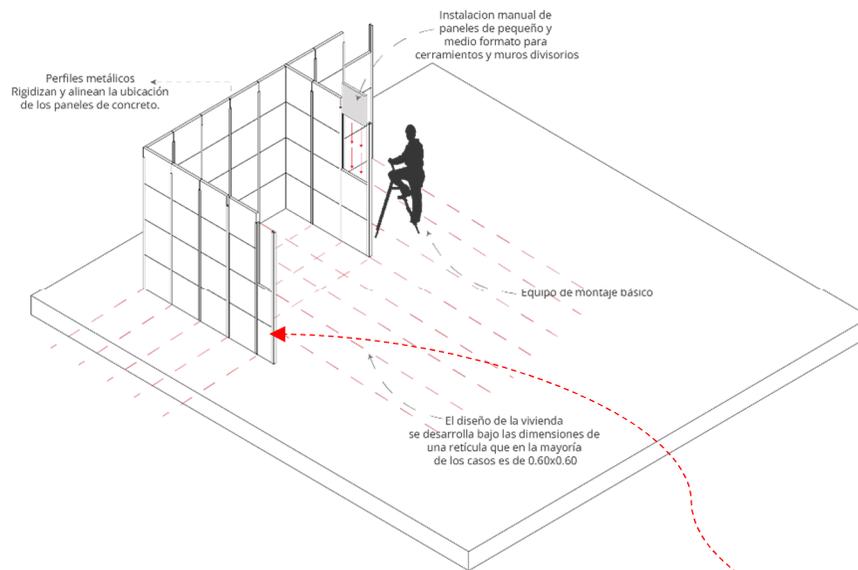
esquema gráfico sistema montaje de paneles en hormigón con estructura metálica
